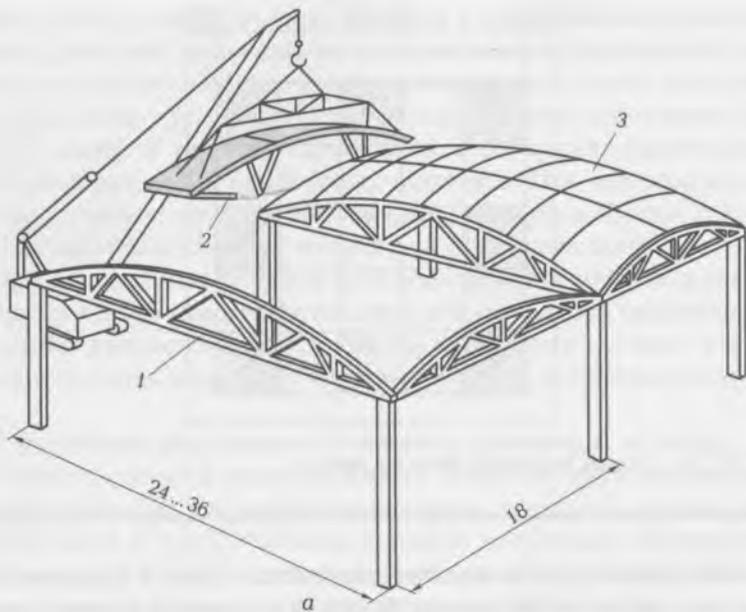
Схемы установки оболочек с опиранием на несущие конструкции:
